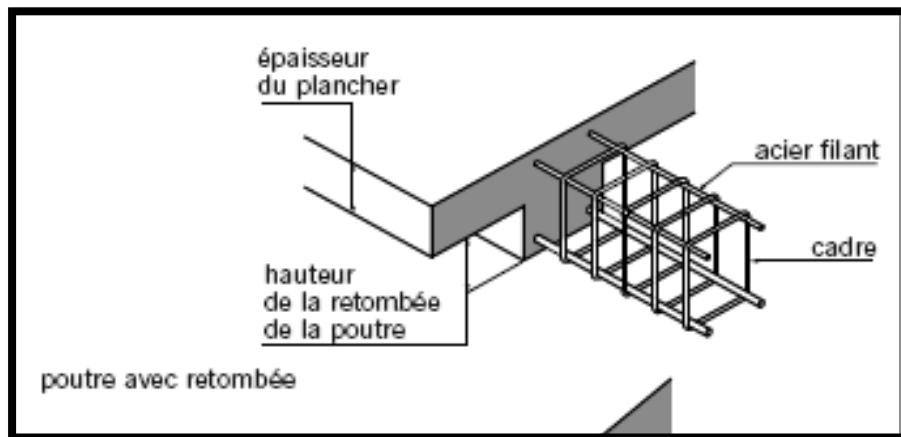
coupe au niveau d'une poutre<sup>92</sup>
